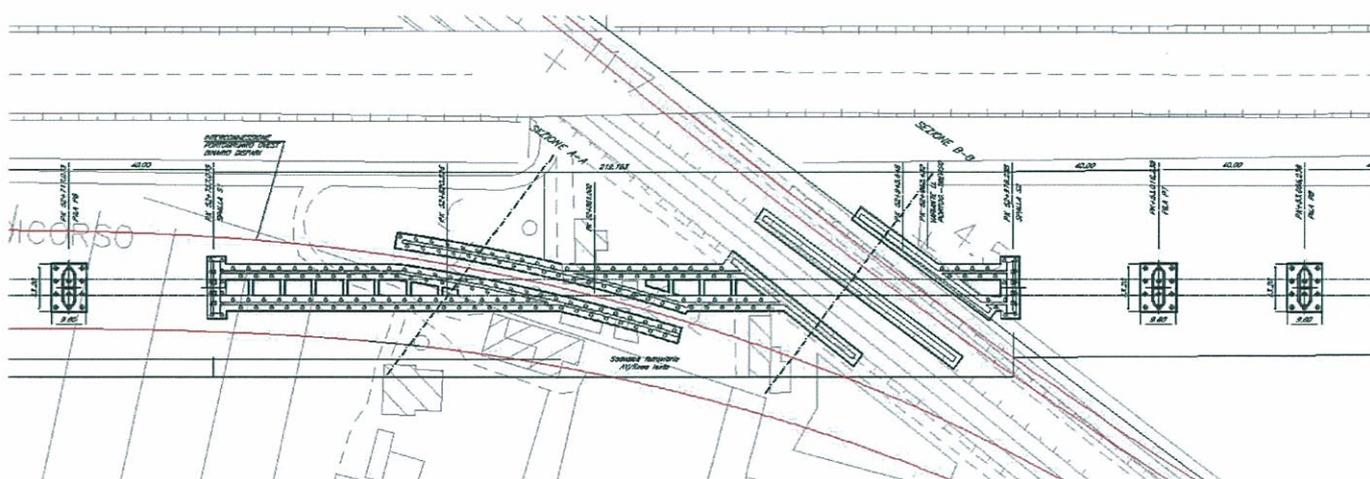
Pianta fondazioni opera di scavalco della Interconnessione Portogruaro Ovest (binario dispari)
